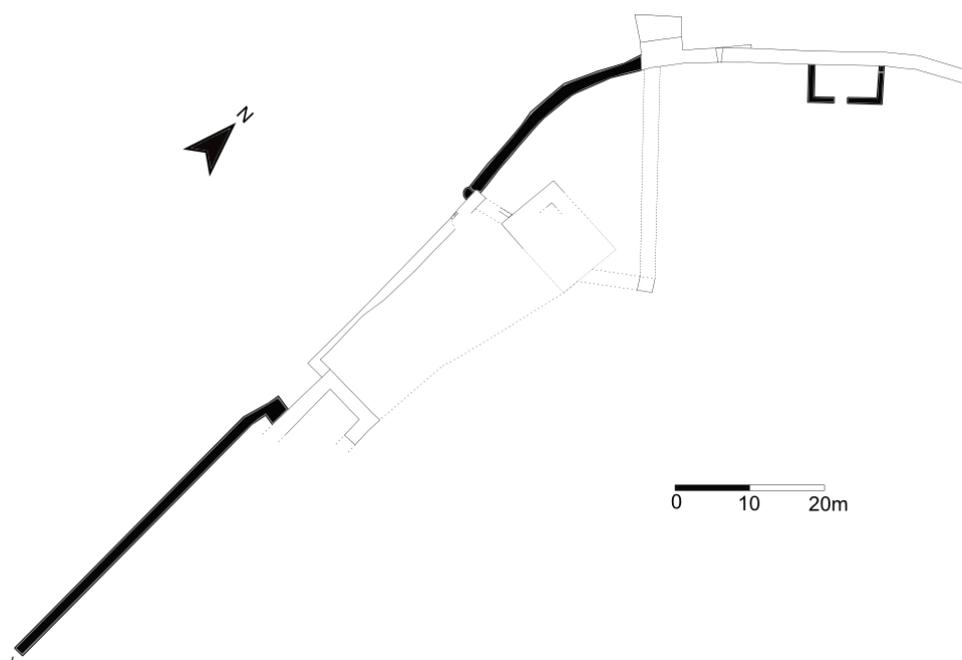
Planta do castelo de Alenquer na fase 3a.
